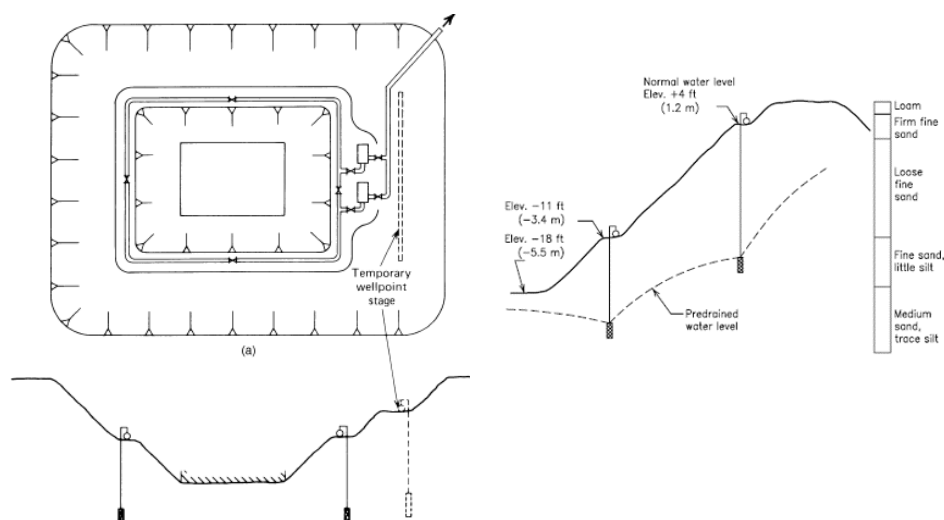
Sistema *wellpoint* multiestadio. Fuente: *Construction Dewatering and Groundwater Control* (Powers, J.P., 2007).
